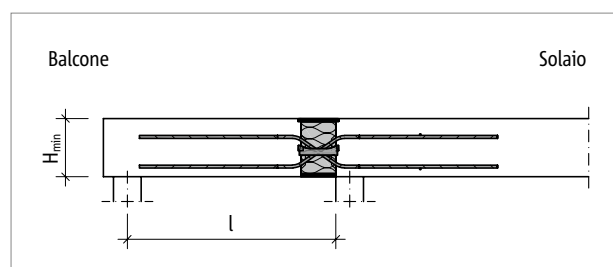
Schöck Isokorb® XT tipo QL-VV: schema statico (XT tipo QL-VV5 – VV8)
